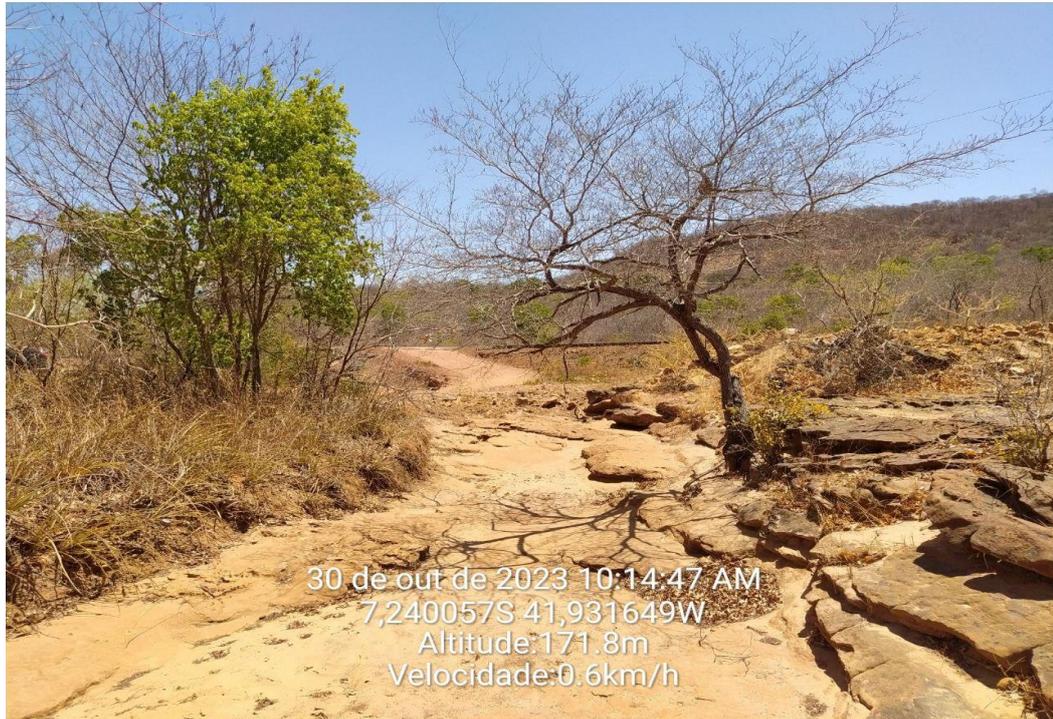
PASSAGEM MOLHADA 04 - TRECHO 03
